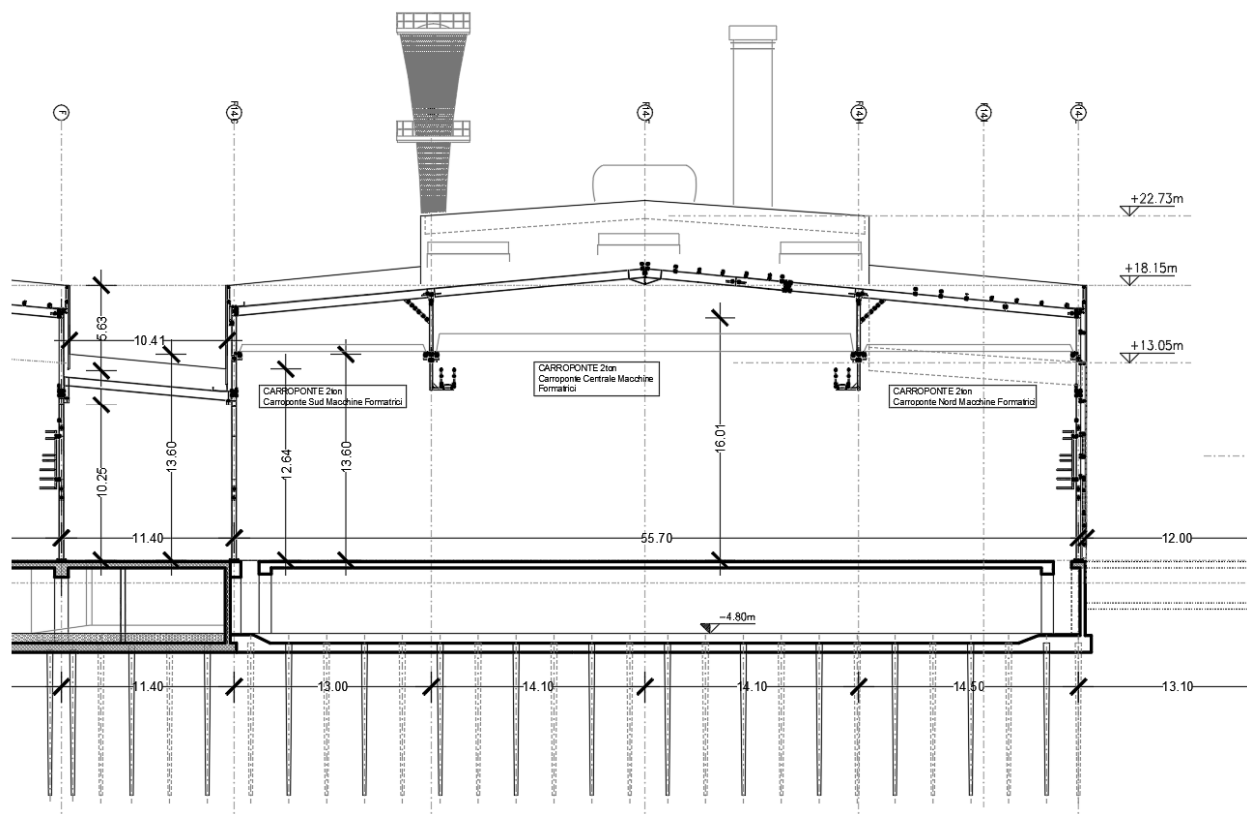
Sezione trasversale Macchine Formatrici e Cantina
